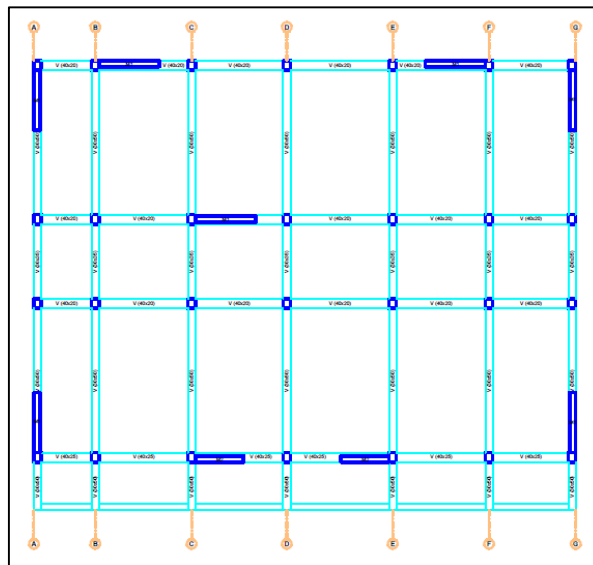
Plano de estructuración con muros de corte propuestos del Módulo C
